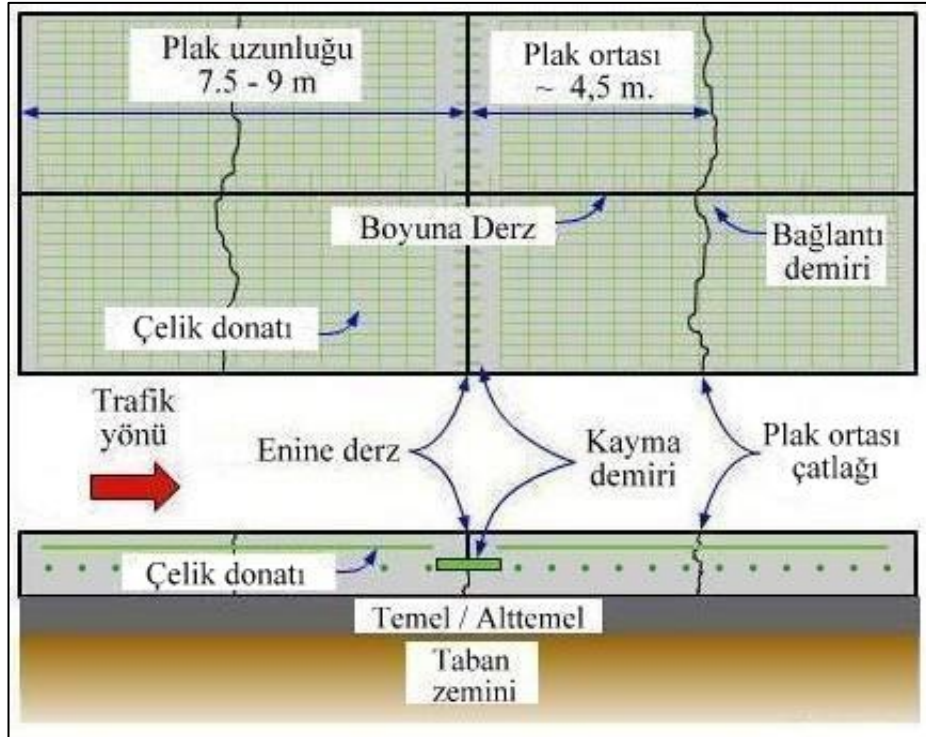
Derzli donatısız beton kaplamaya ait plan (üstte) ve kesit (altta) görüntüsü [13].
